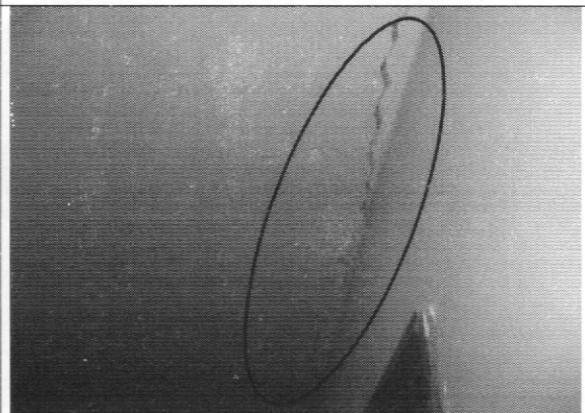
Grieta en placa de entrepiso primer nivel
